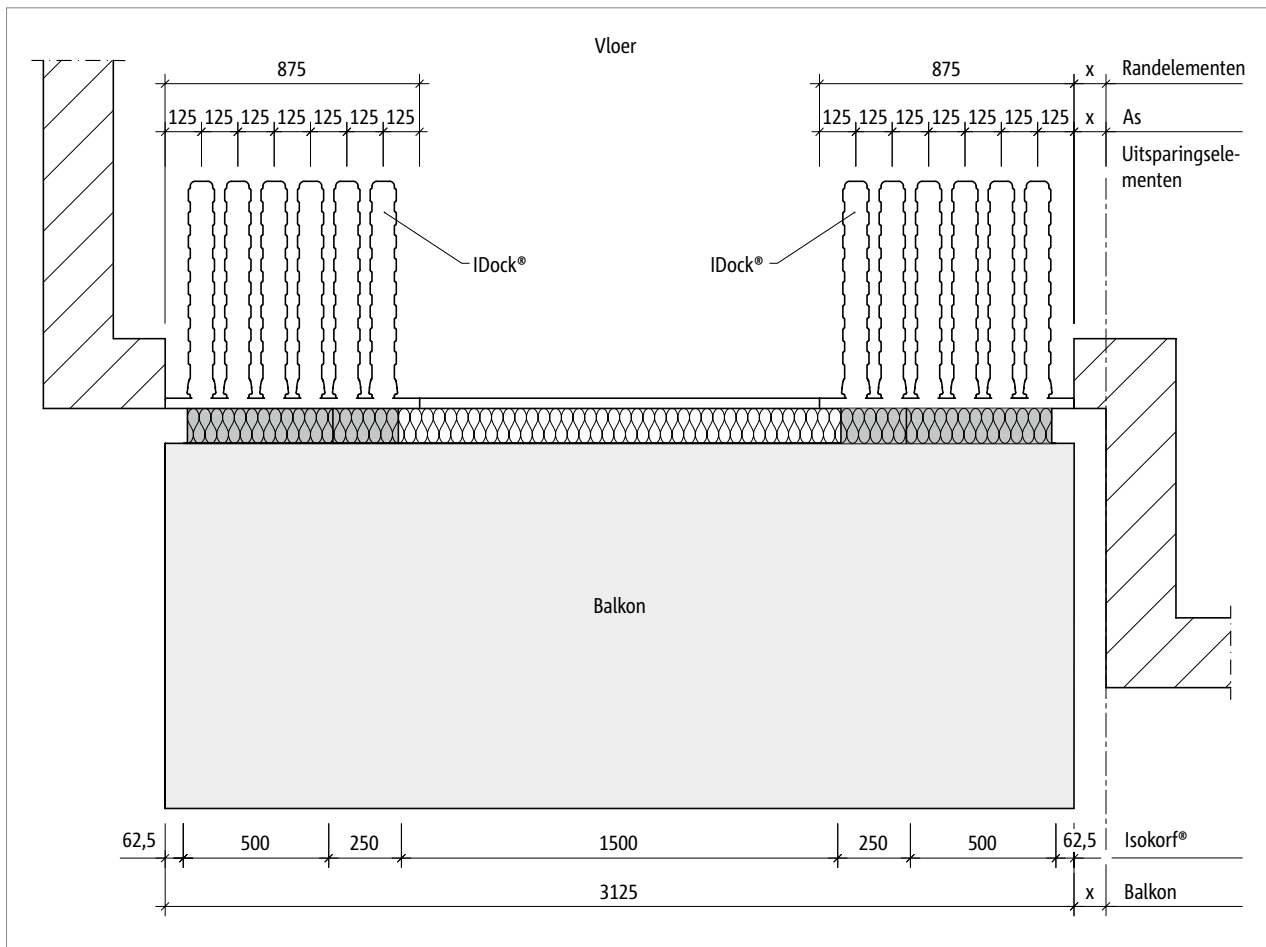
Schöck IDock®: Positie van balkons op de hoek van het gebouw
